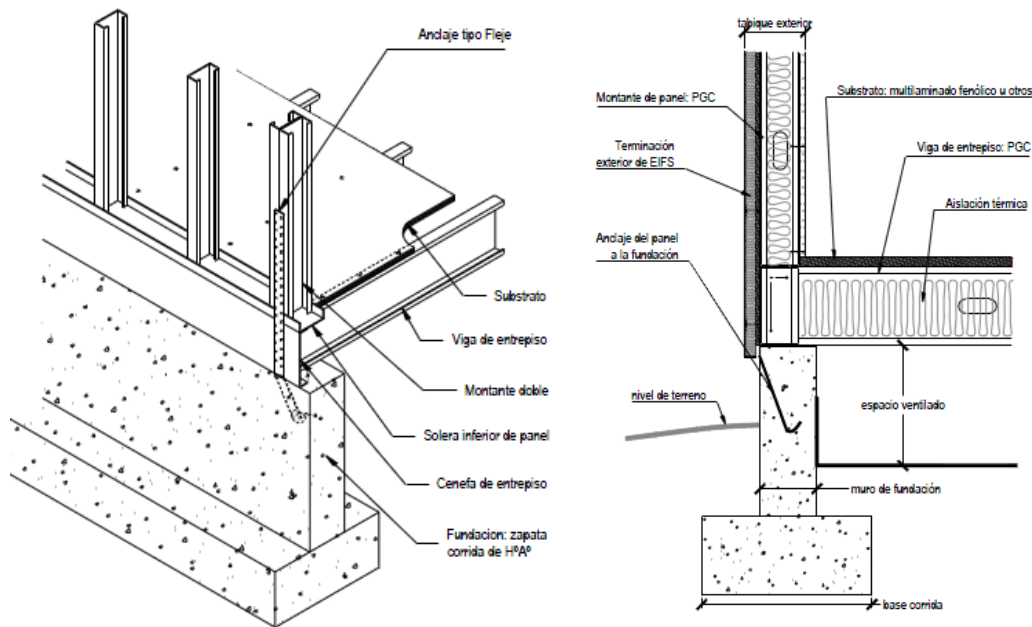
Detalle de anclaje a cimentación. (ConsulSteel, 2002).
